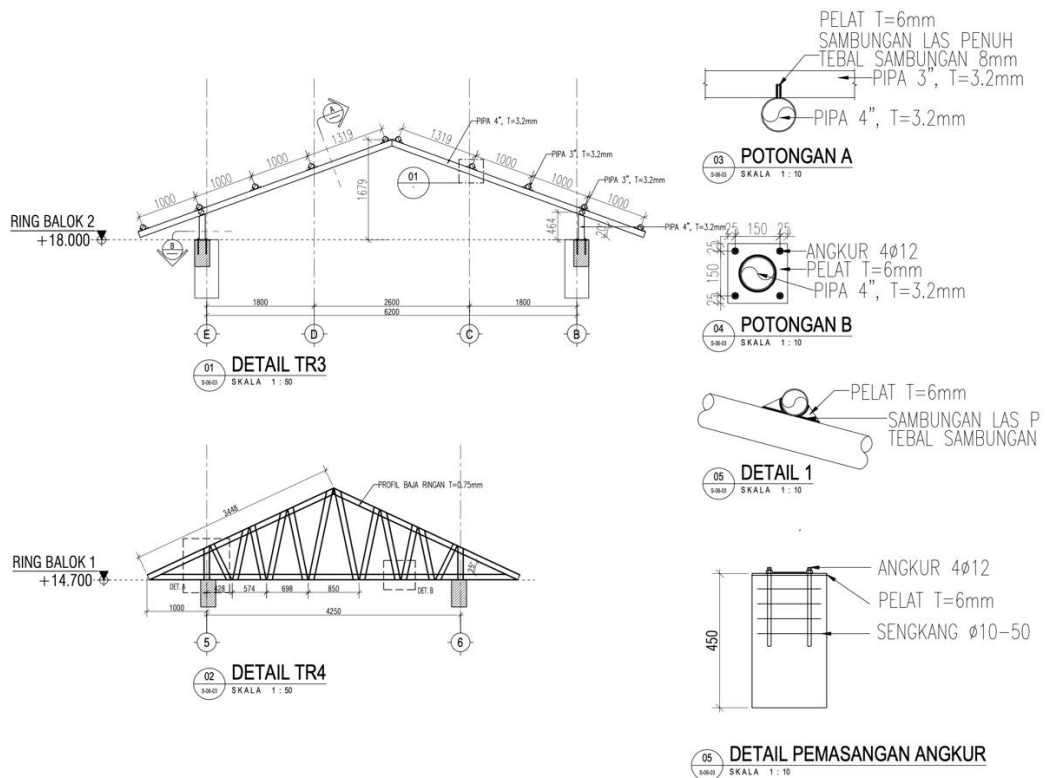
106 Contoh Detail Rencana Atap Baja Ringan
